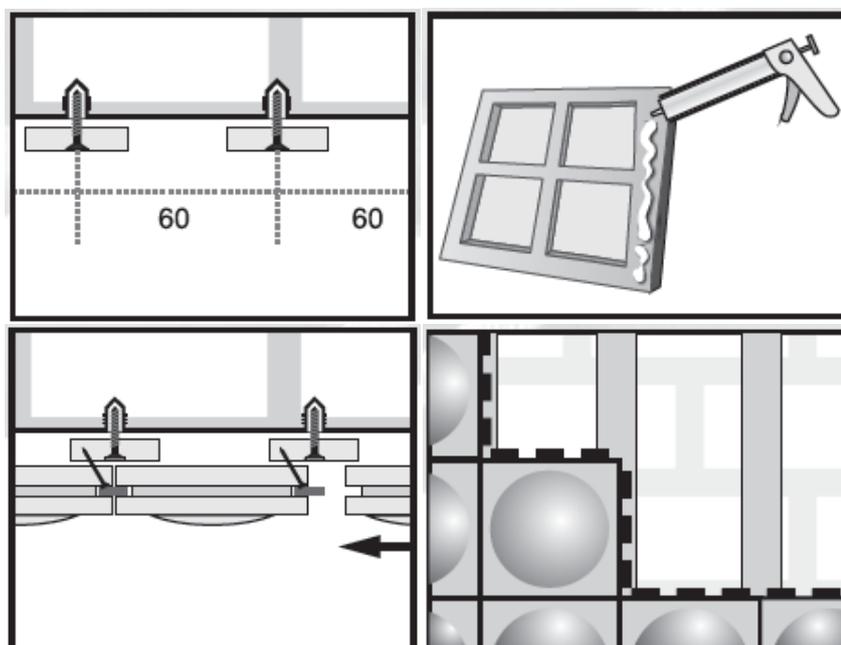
Installazione su profili di legno. Tra gli elementi è posta una guarnizione per rendere i giunti a vista
